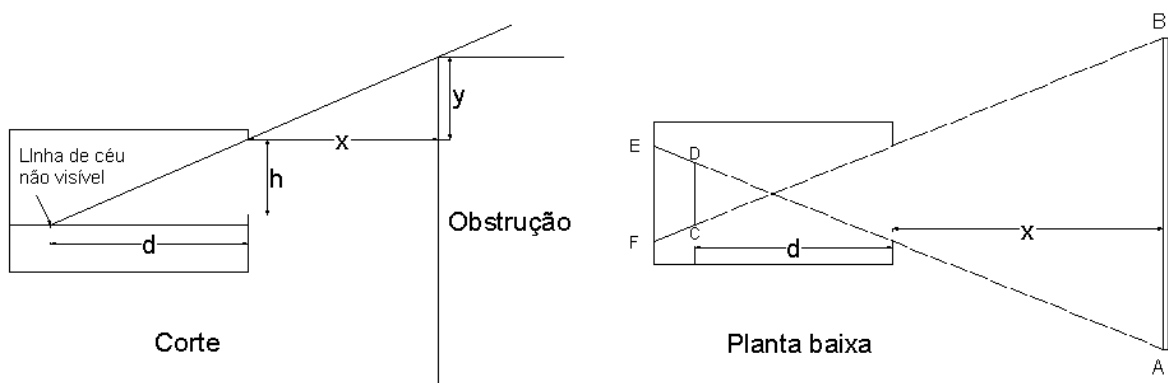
14 – Corte e planta baixa com a linha de não visão do céu (LITTLEFAIR, 1991)
